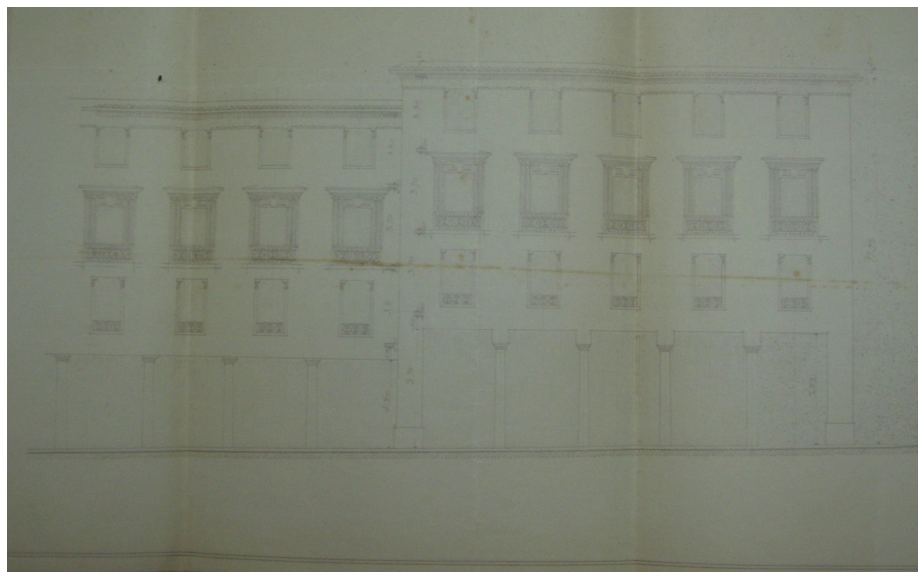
Façade type, place Lyautey (avenue Dar El Makhzen).
